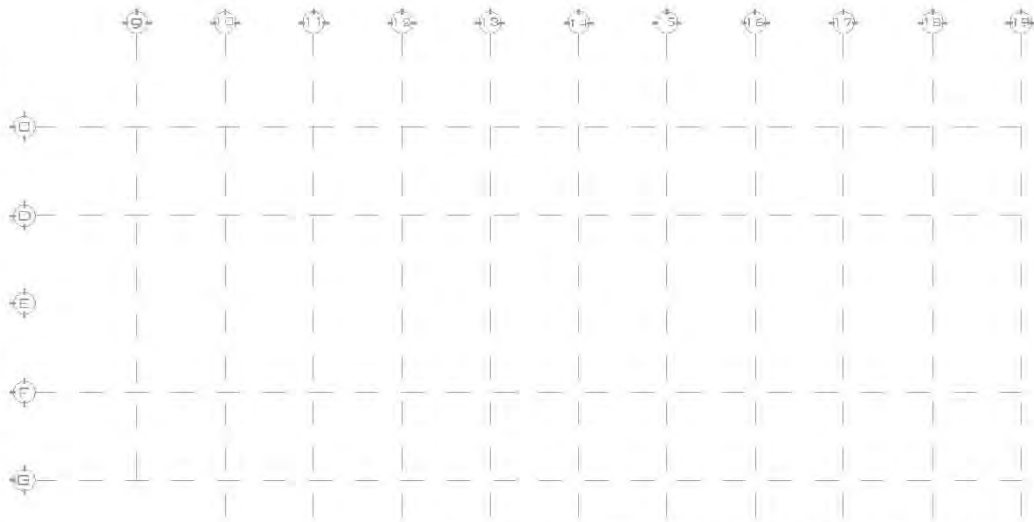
Modulación de estructura 12.20x 12.20 m.
